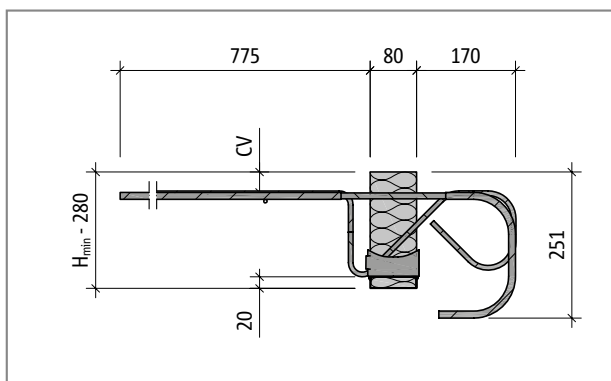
Schöck Isokorb® tipo K70M-UZ – K110M-UZ: Sezione dell'elemento
